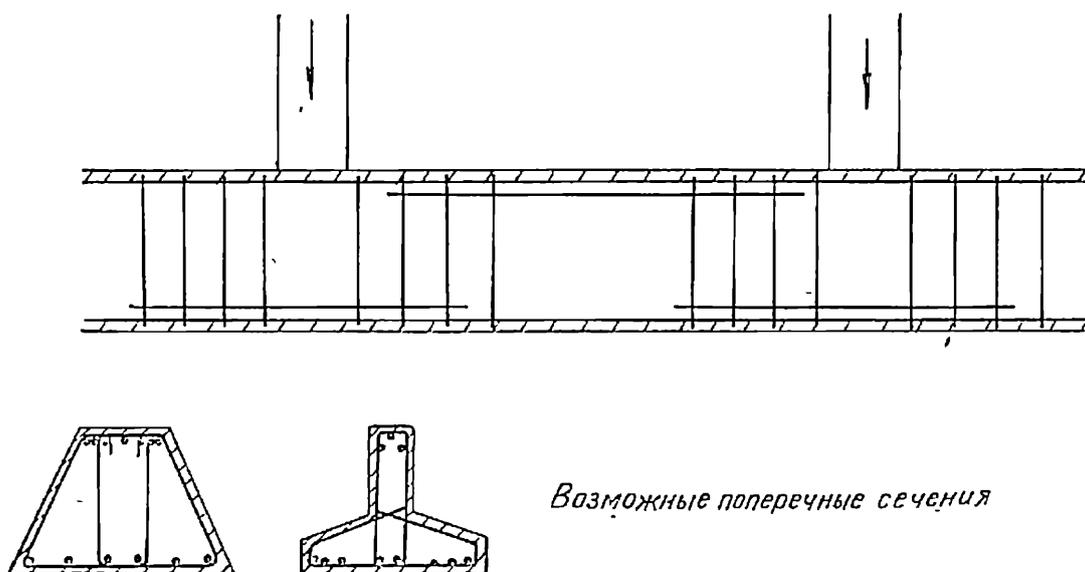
16. Фундаментная плита с достаточной строительной высотой армирована простой арматурой
